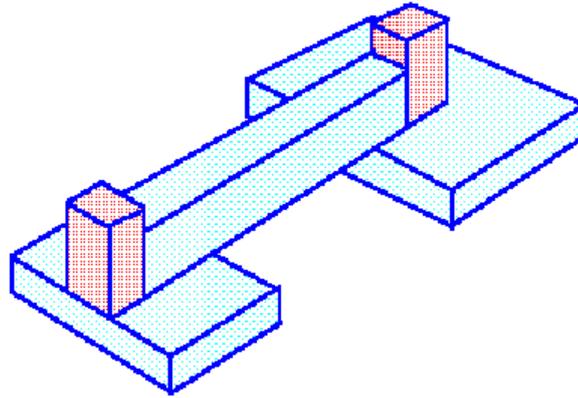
Zapata aislada y viga de fundación. Fuente Sitio Web Escuela Politécnica del ejército de Ecuador
